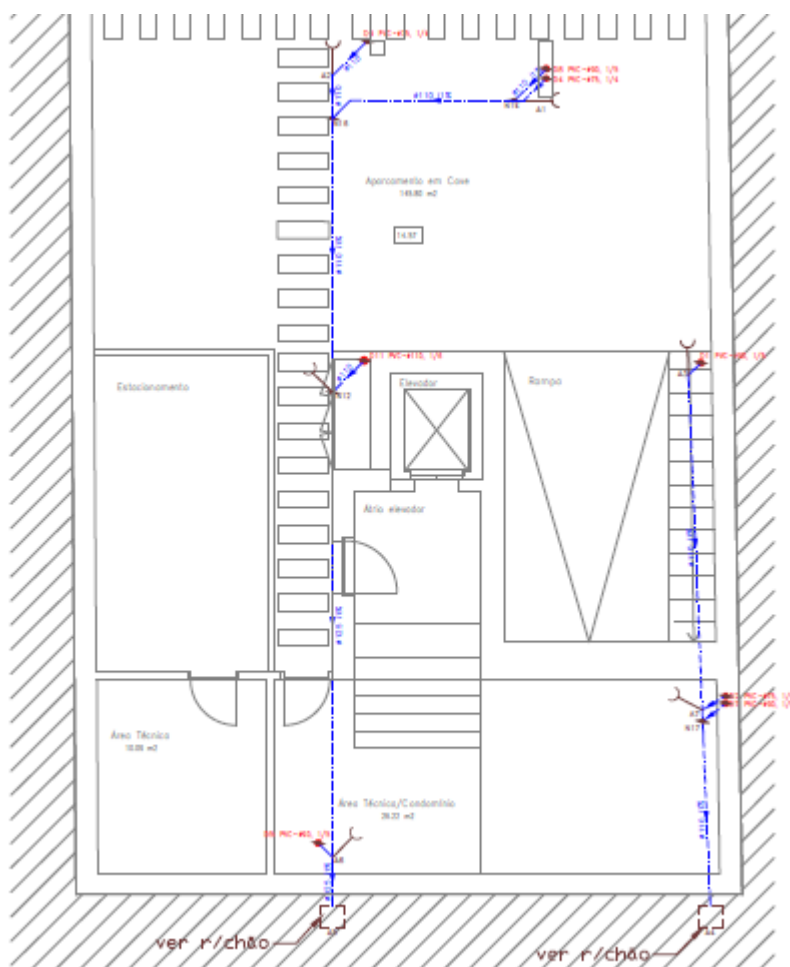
Planta de drenagem de águas residuais da cave obra N°5.
